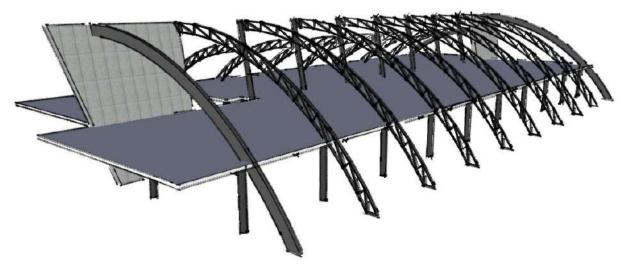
Diagrama estructural. Cerchas, columnas, losa y elementos estructurales. Fuente: Elaboración propia. (2018).
